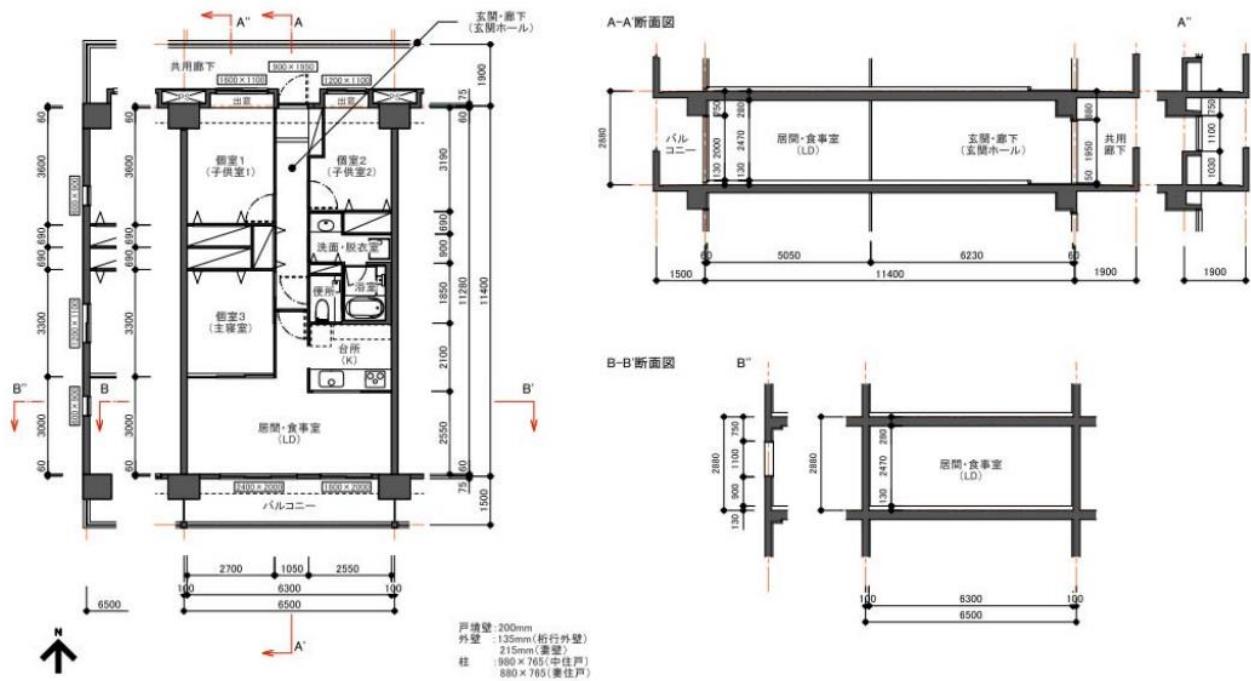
3LDKリビング横長モデルの平面図・断面図
